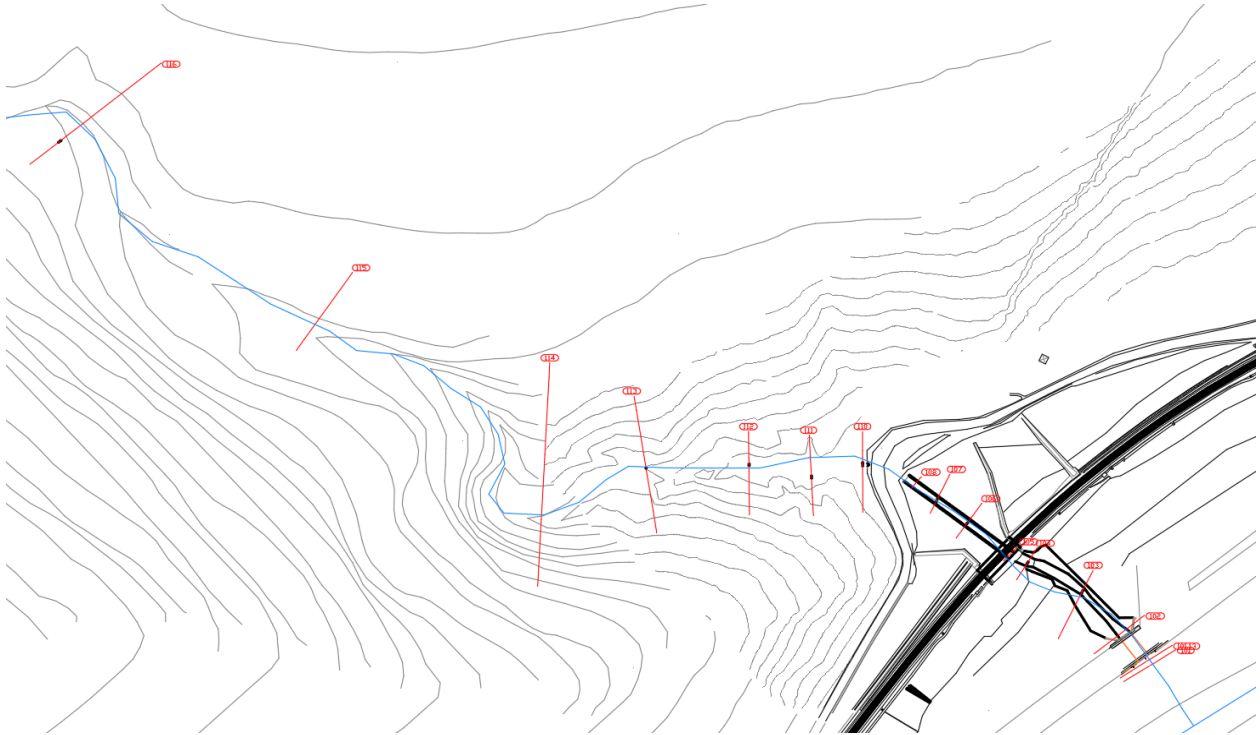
Schema planimetrico dell'asse IN04 in condizioni Ante Operam
